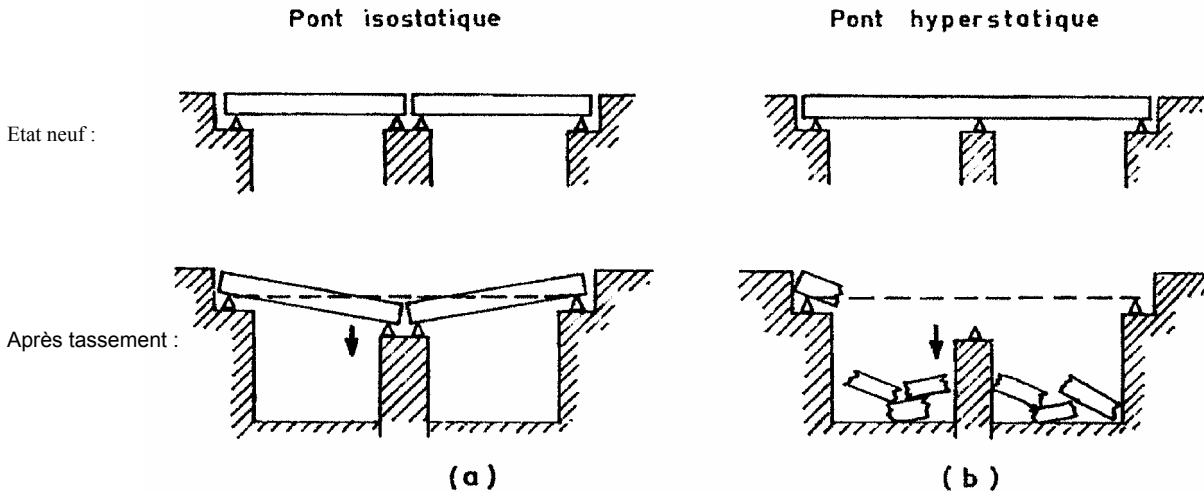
Effet du tassement de la pile centrale sur un pont à deux travées.
